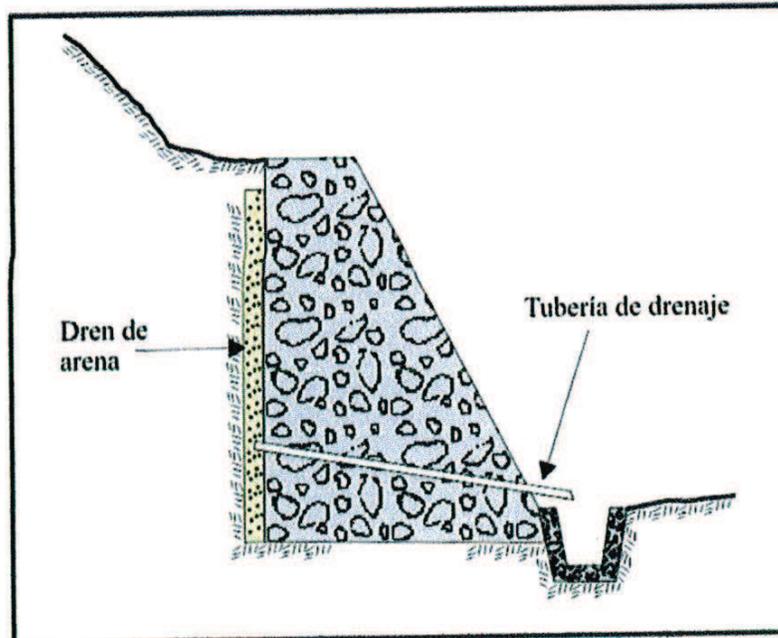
Muros de gravedad de concreto ciclópeo (tomado de INGEMMET, 2000).
